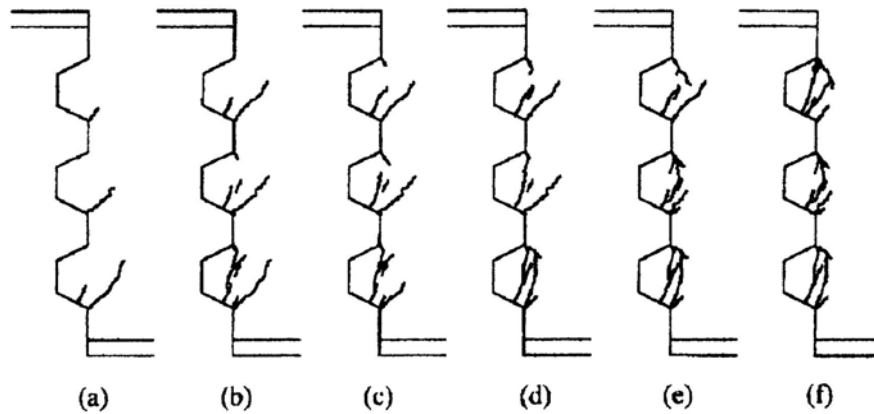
Secuencia de la fisuración para juntas secas con llaves múltiples
